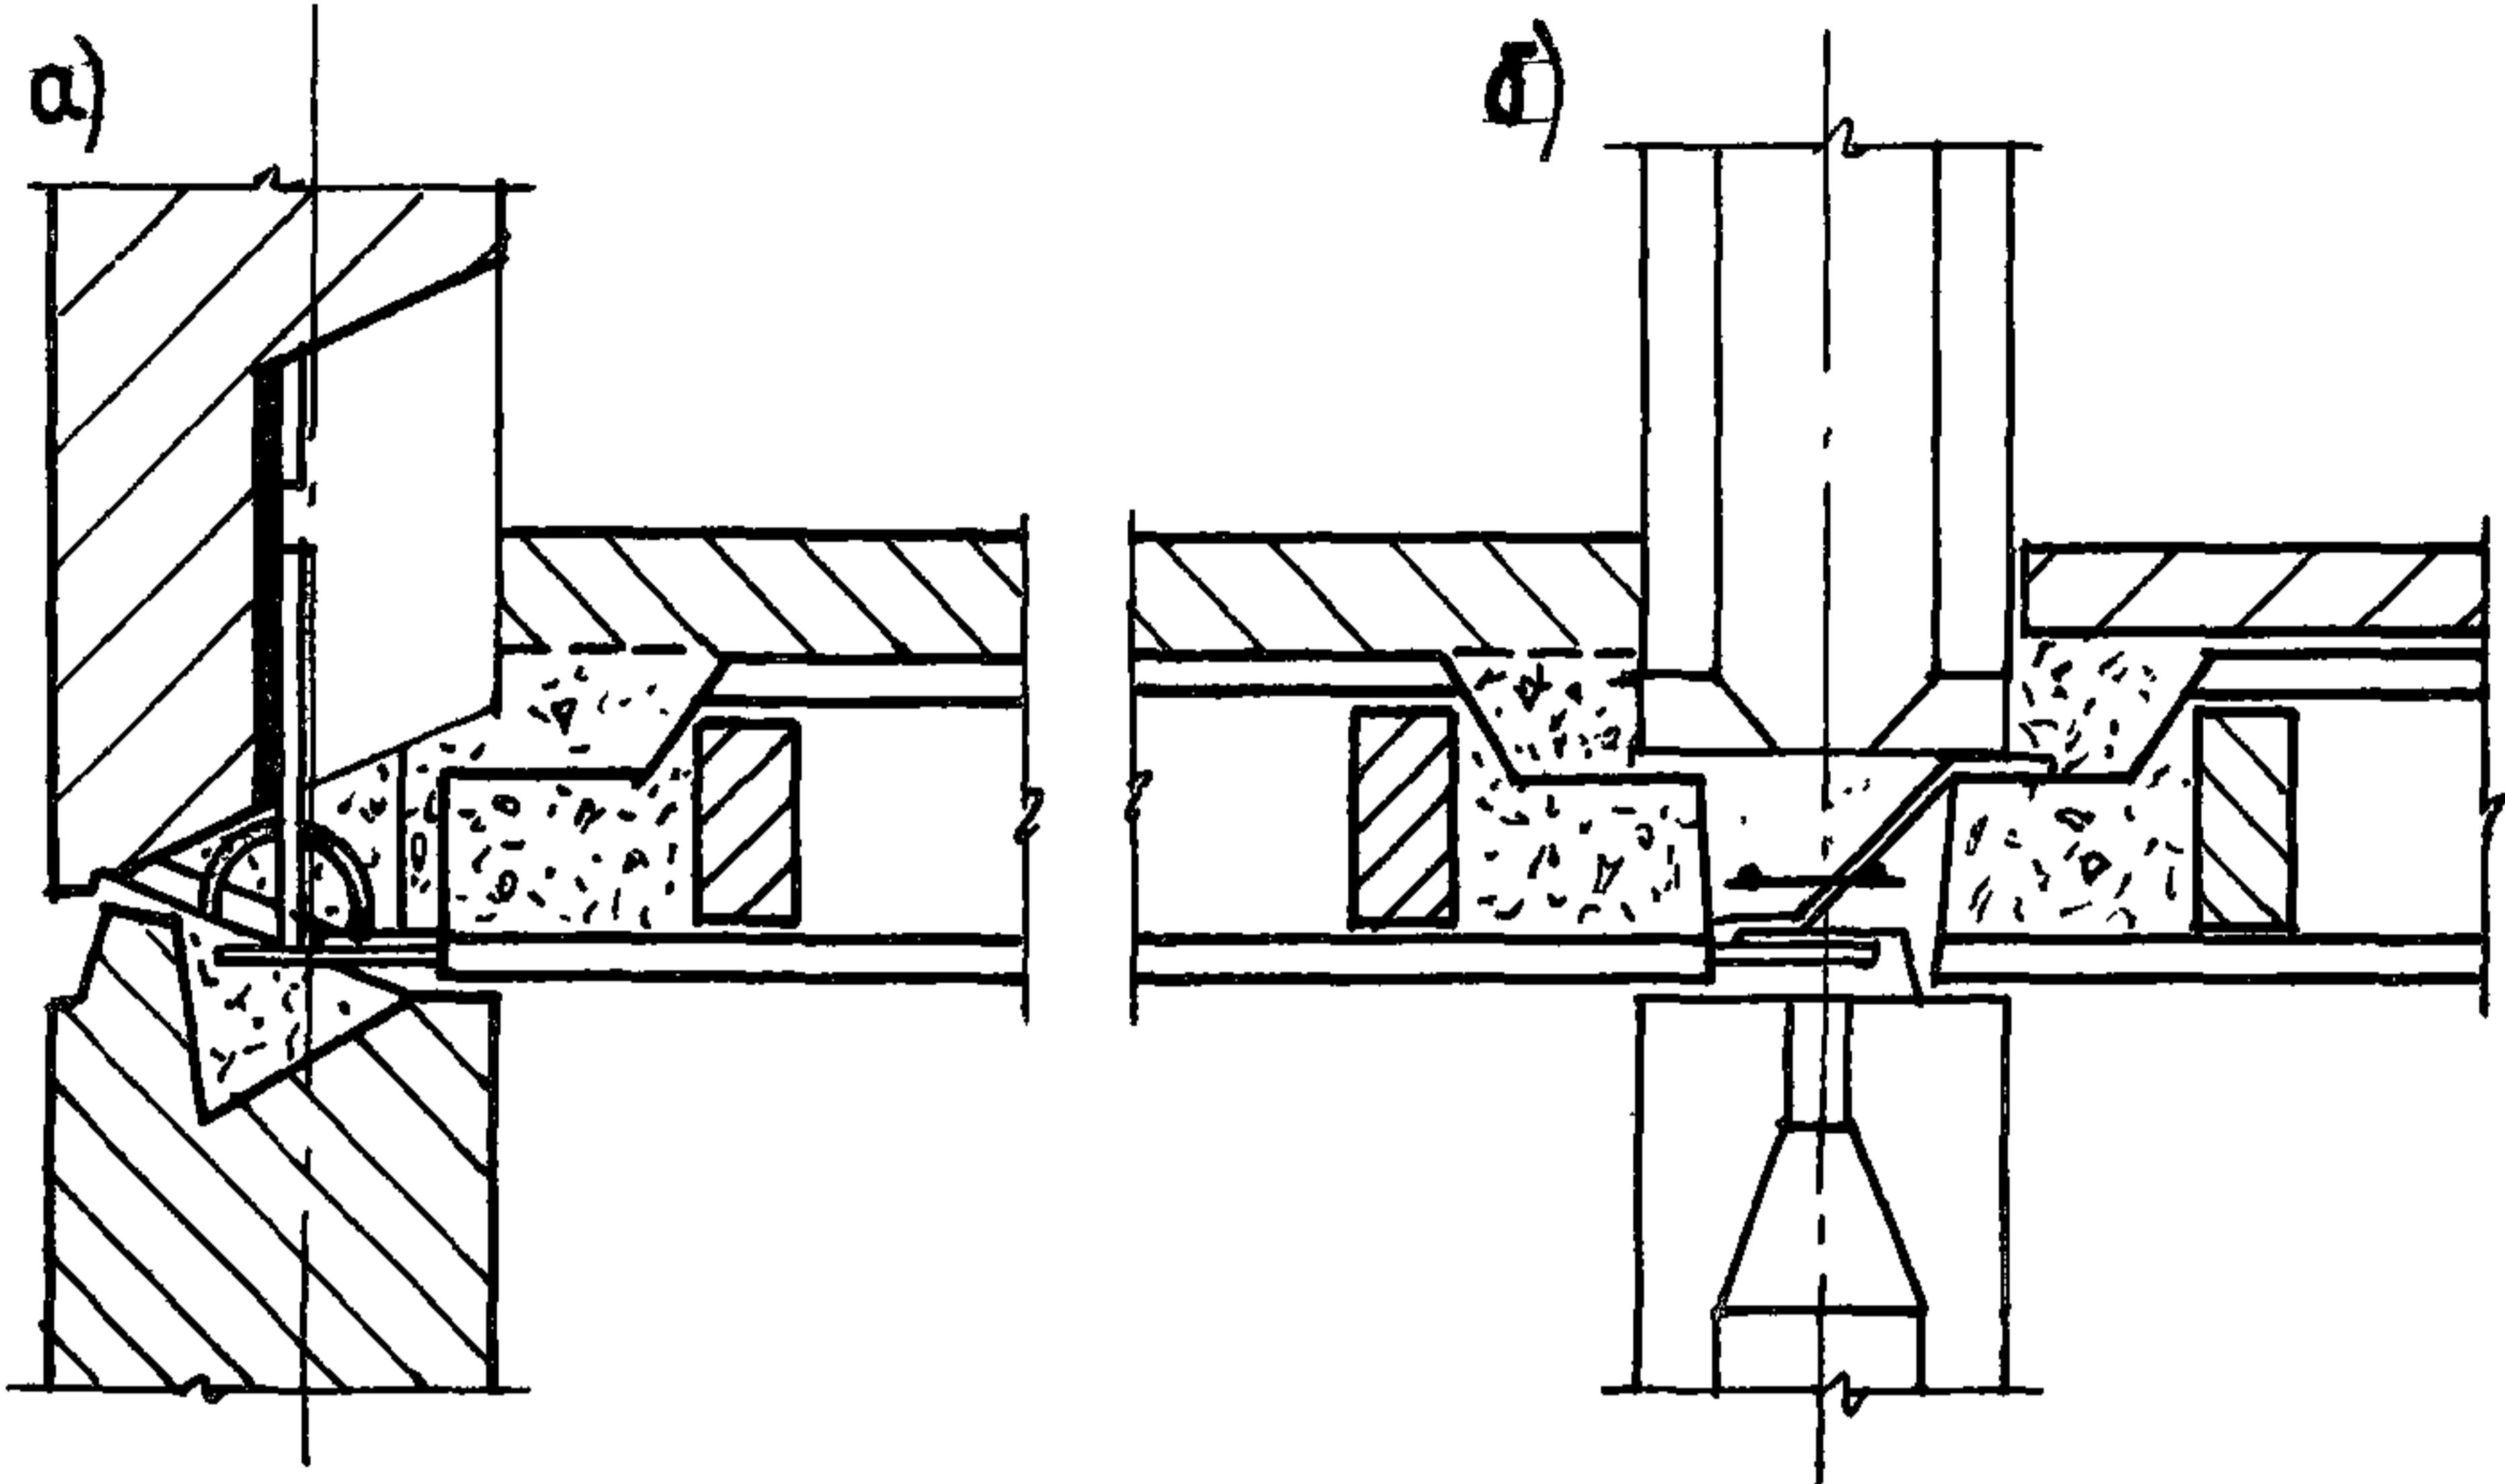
Монолитный горизонтальный стык многопустотных плит перекрытий с наружной (а) и внутренней (б) стеной
